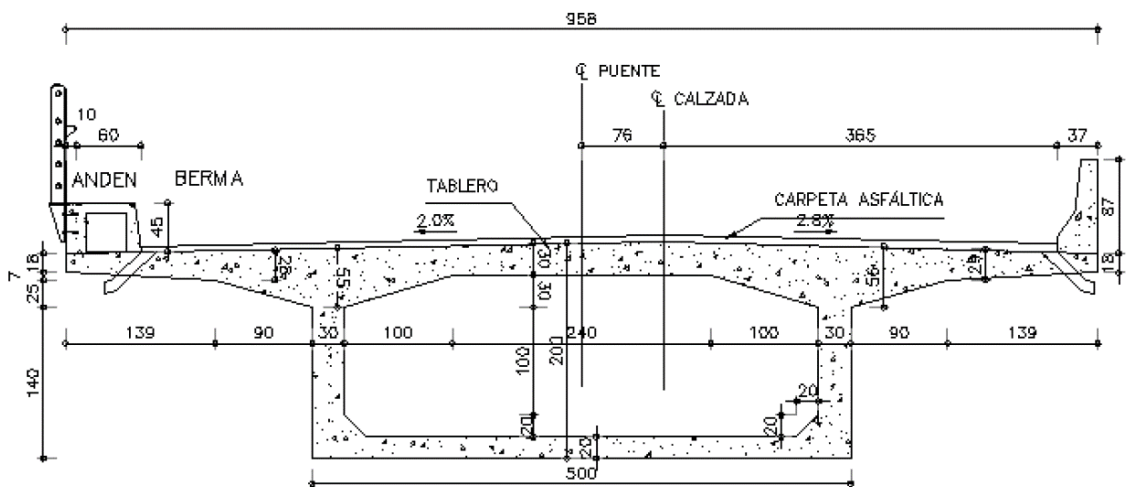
Sección transversal centro de luz de la superestructura del puente Bermúdez.
